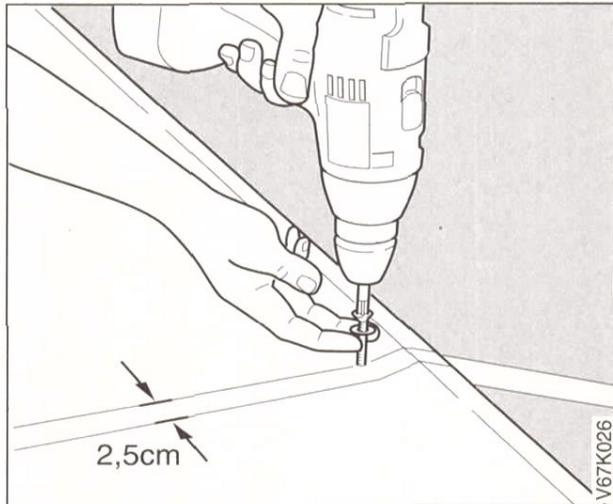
Zwischen die Überlappung der oberen Eindeckbleche Silikon auftragen und mit vier Spenglerschrauben verbinden. Zu den Blechrändern ca. 2,5 cm Abstand einhalten.
